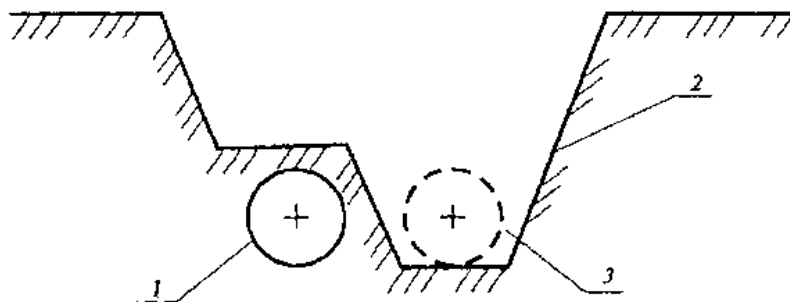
Профиль траншеи при ремонте с заменой труб путем укладки в совмещенную траншею: 1 – заменяемый участок нефтепровода; 2 – траншея; 3 – вновь прокладываемый участок нефтепровода
